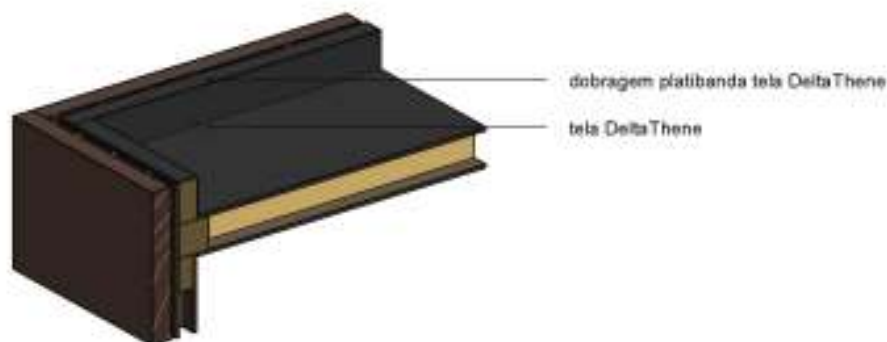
Aplicação da membrana de impermeabilização na cobertura e platibanda.
